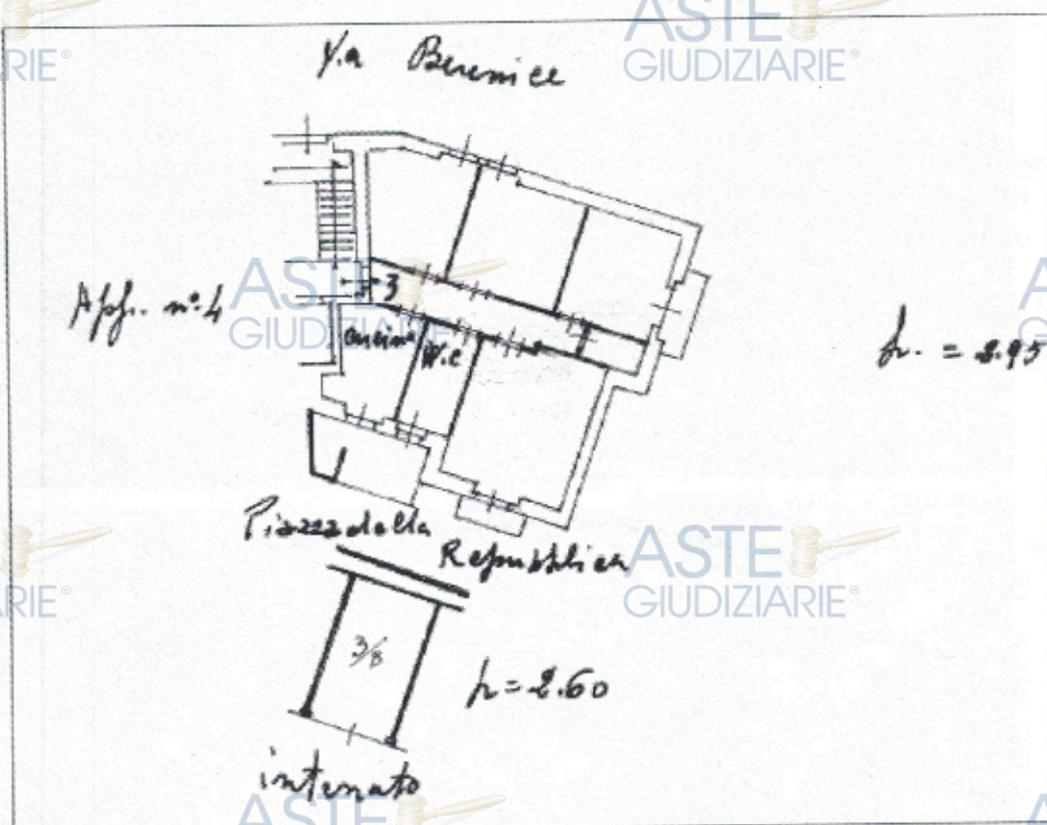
estratto planimetria catastale dell'appartamento e del garage
